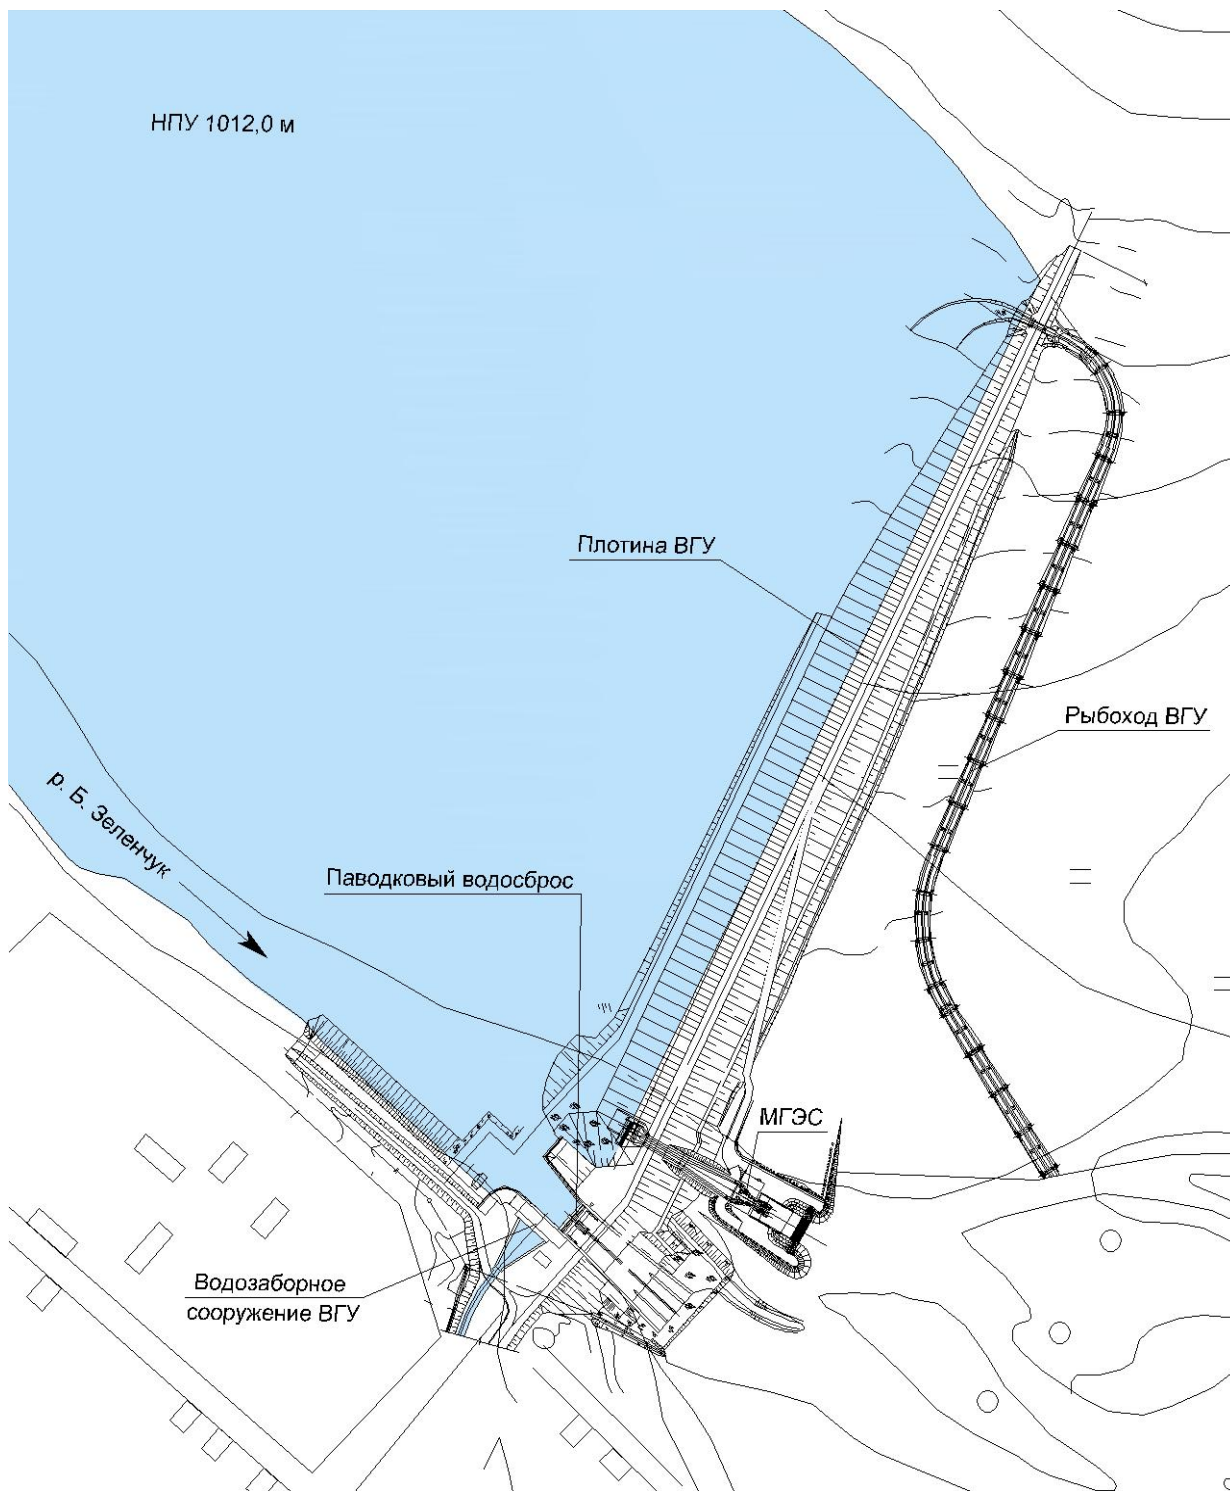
План водозаборного гидроузла на р. Большой Зеленчук.
